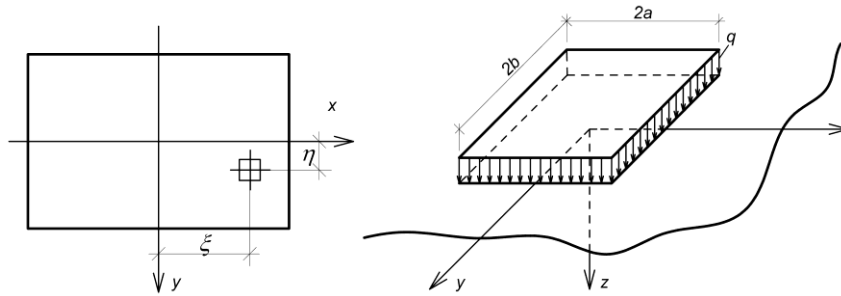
Расчетная схема приложения прямоугольной нагрузки на основание
